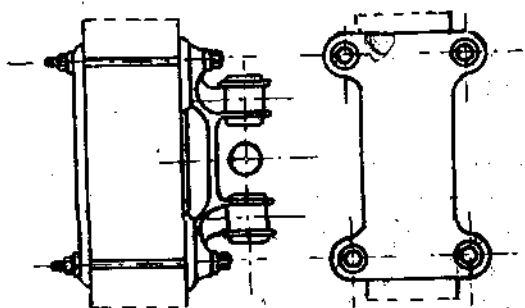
и 232. Прикрепление трансмиссий к железобетонным стойкам.
